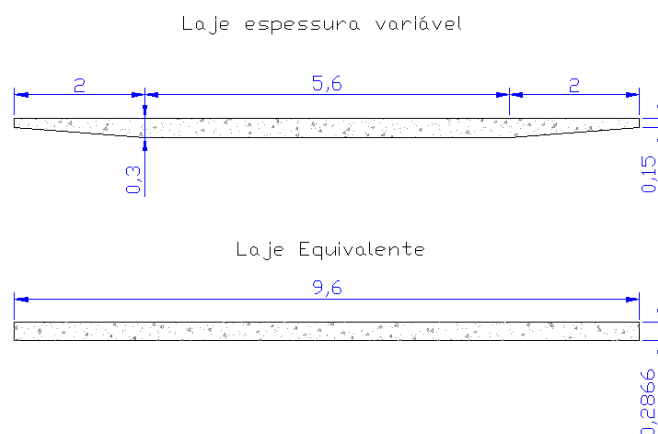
Dimensões de laje de espessura variável e laje equivalente.
